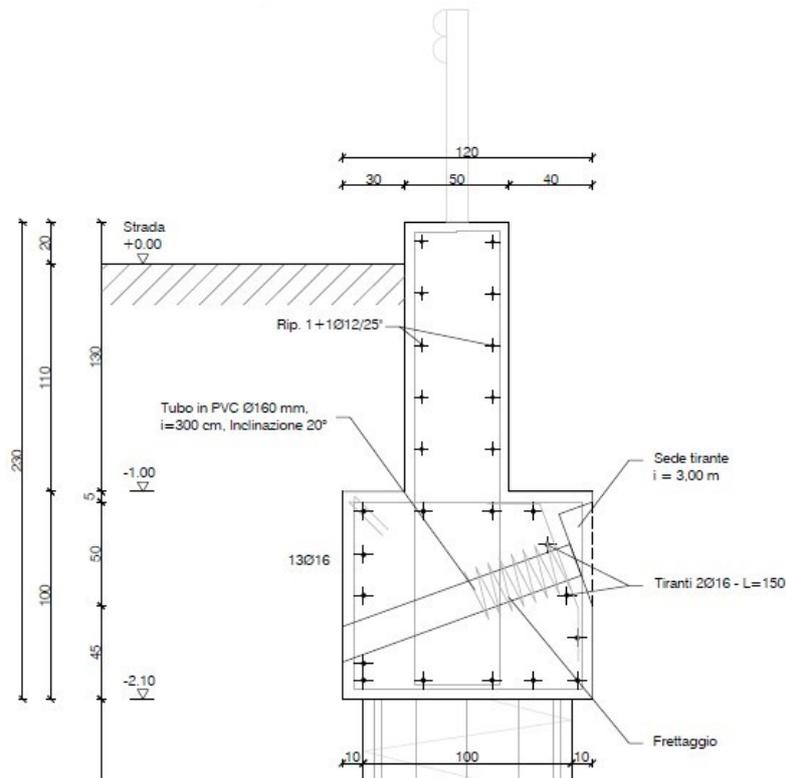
Sezione tipo del cordolo e del muretto dell’opera di consolidamento
